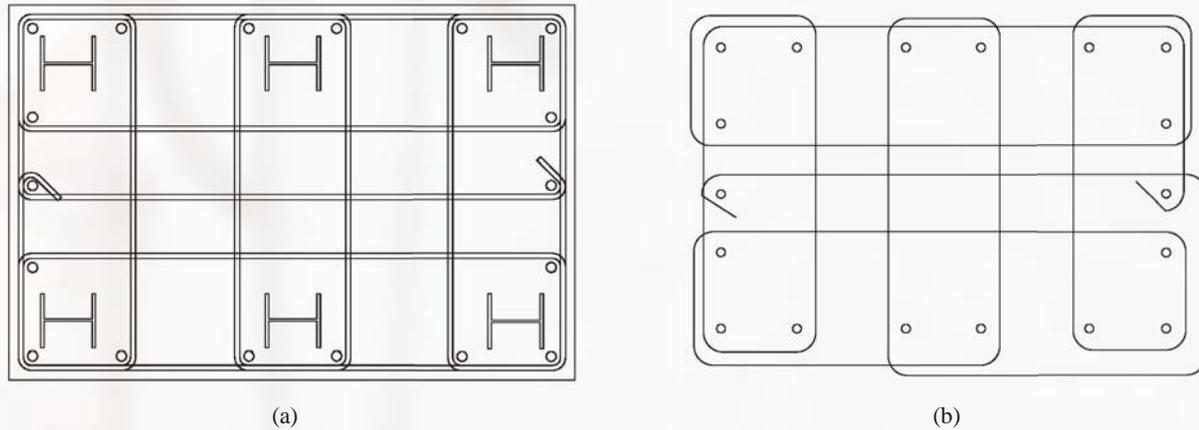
鋼及混凝土複合式橋柱斷面配置示意圖 (a) 斷面配置；(b) 一筆箍箍筋
